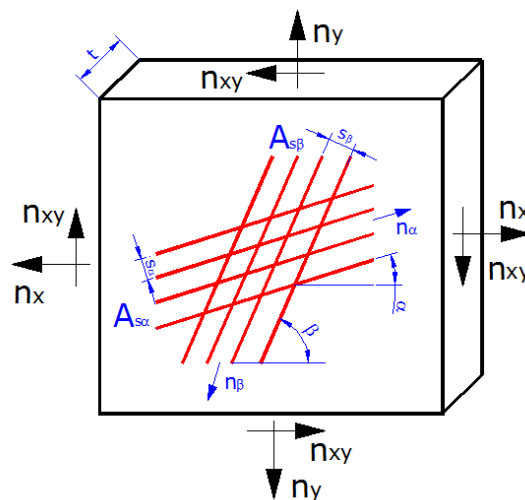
Elemento de membrana em concreto armado sujeito a estado plano de tensões
